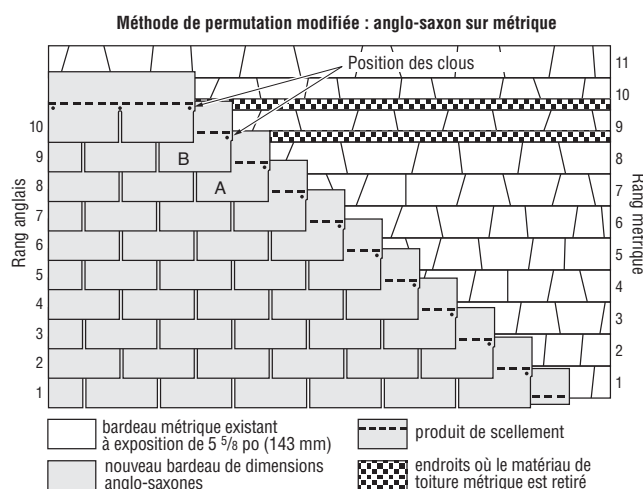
Réfection d'un toit au moyen de bardeaux standards de 12 po (305 mm) x 36 po (910 mm) sur des bardeaux métriques.
